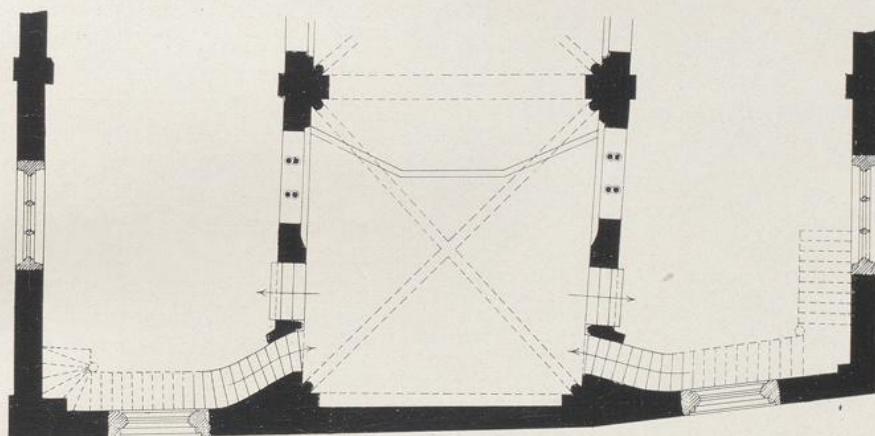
St.-Maria-Lyskirchen. Grundriss der Westempore.
